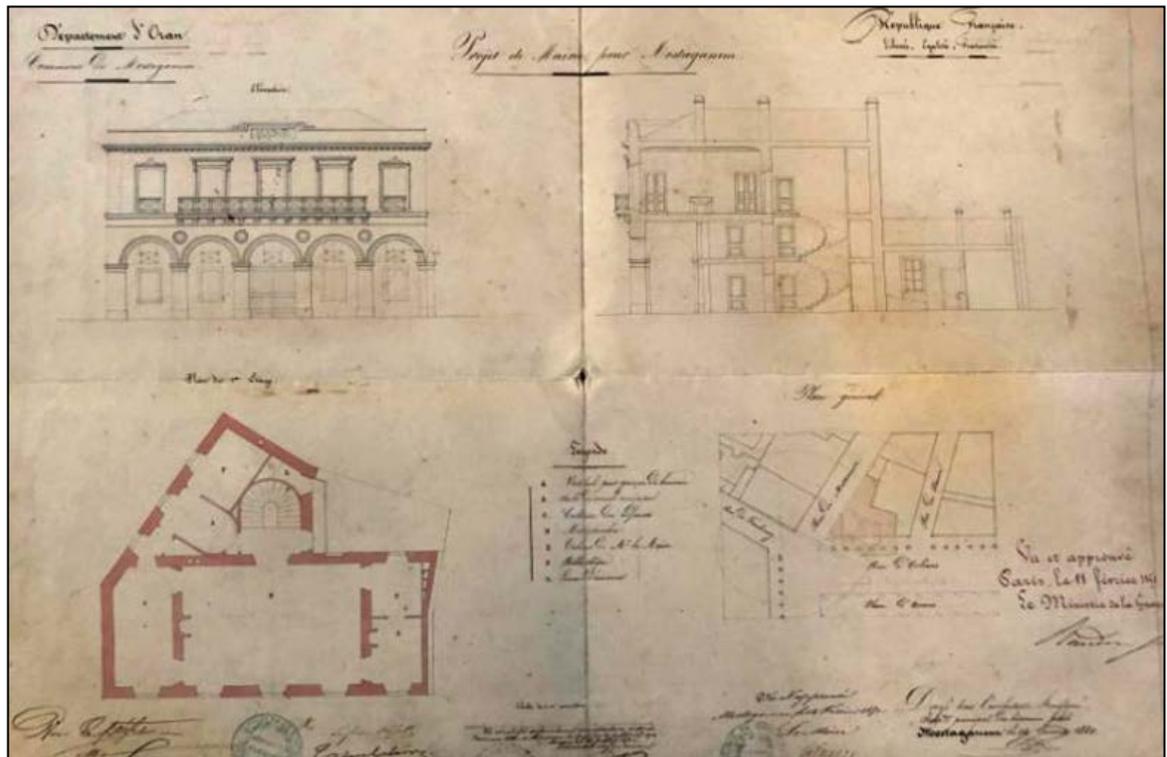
Plan de situation, le plan du 1er étage, coupe et façade principale de l'hôtel de ville de Mostaganem [85].
